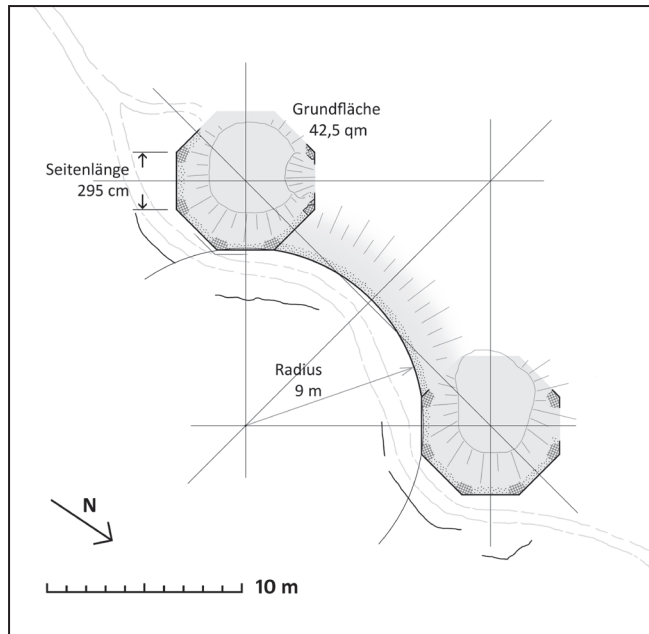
Geometrische Maßverhältnisse im Grundriss [Plan Stefan King]
